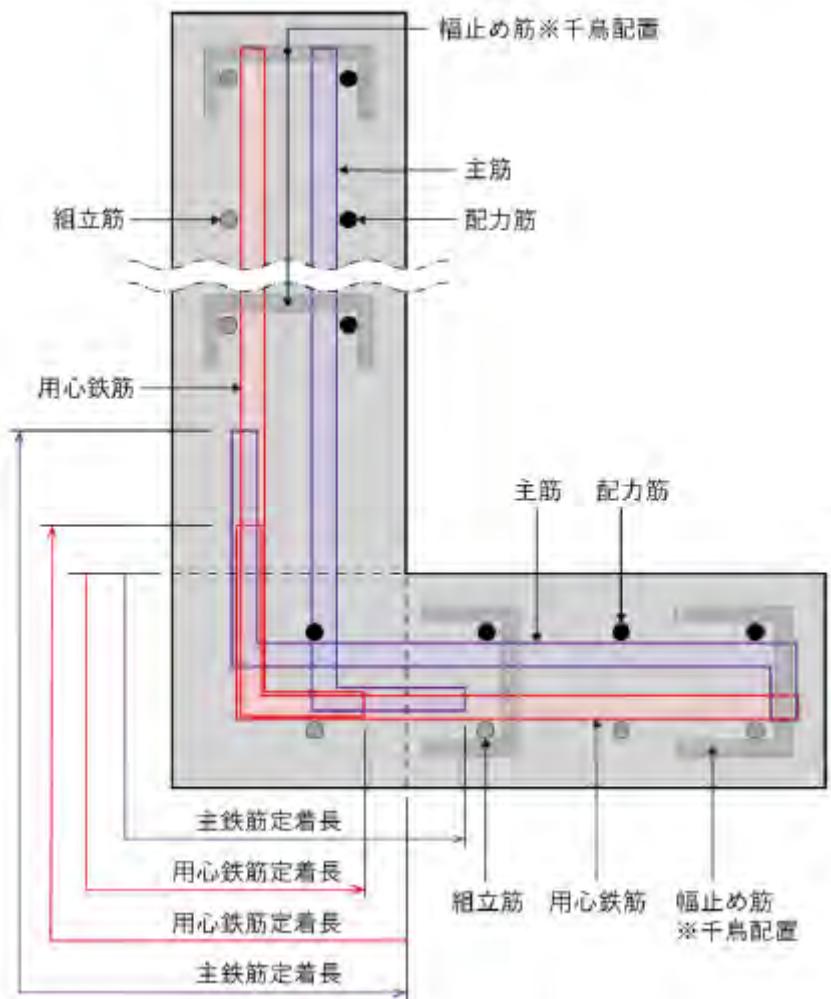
L型鉄筋コンクリート擁壁縦壁基部の配筋要領
